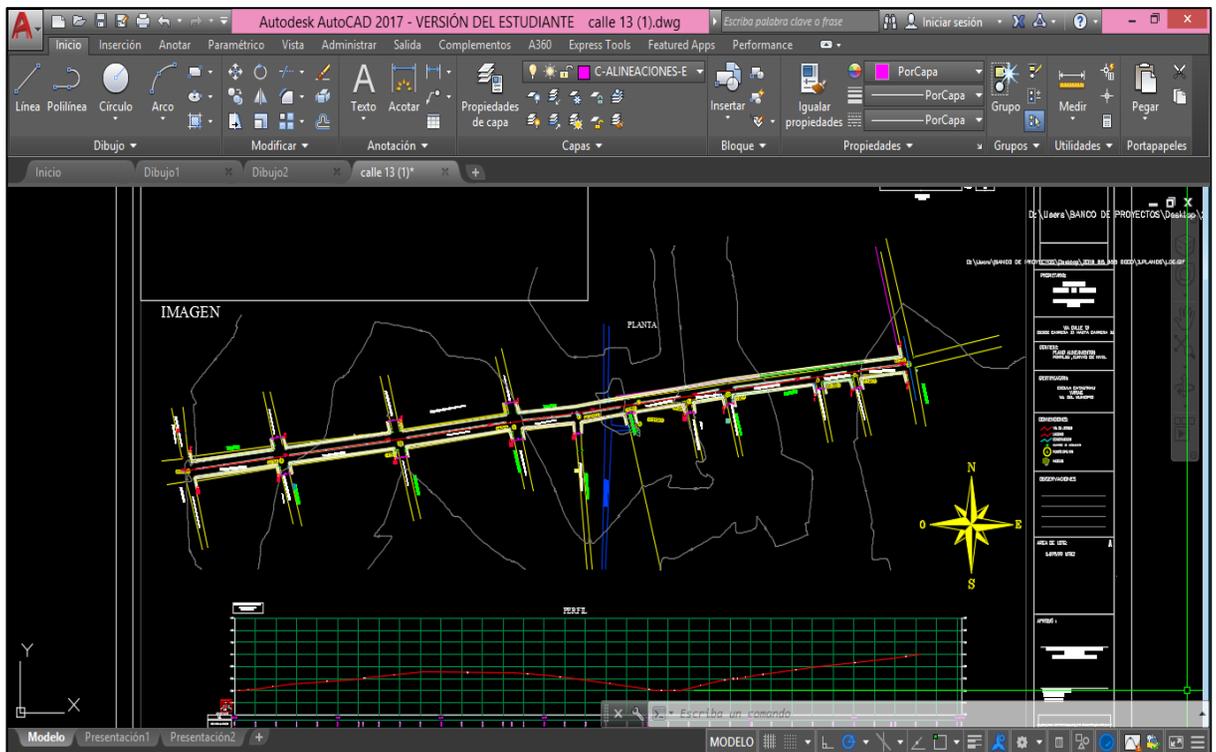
Plano en AutoCAD proyecto Sabana de Torres
